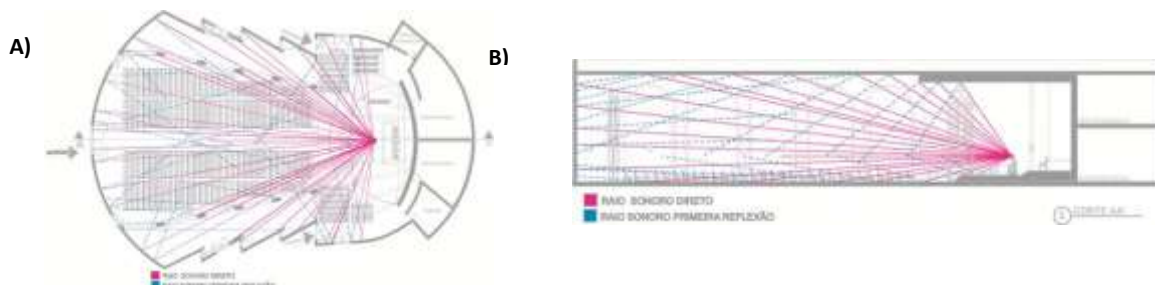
Distribuição dos raios sonoros da Concatedral: (A) planta baixa; (B) Corte transversal.
